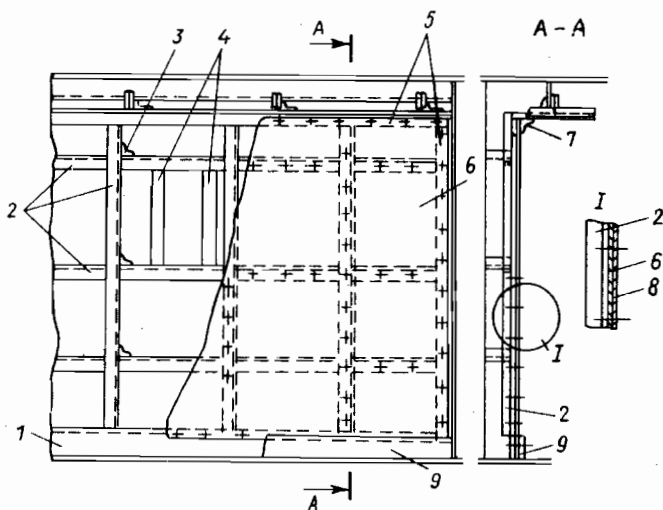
Конструкция зашивки по металлическому обрешетнику.
